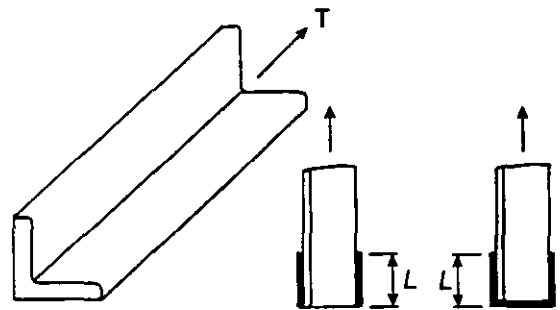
Determinación de L en uniones soldadas.
